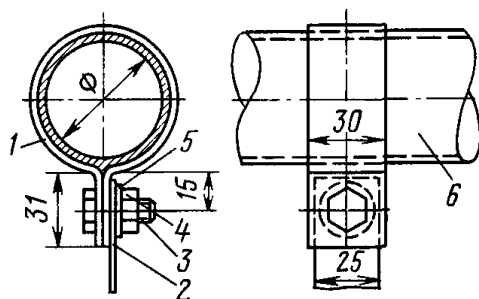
Схема присоединения заземляющего проводника к трубопроводу с помощью хомута:
